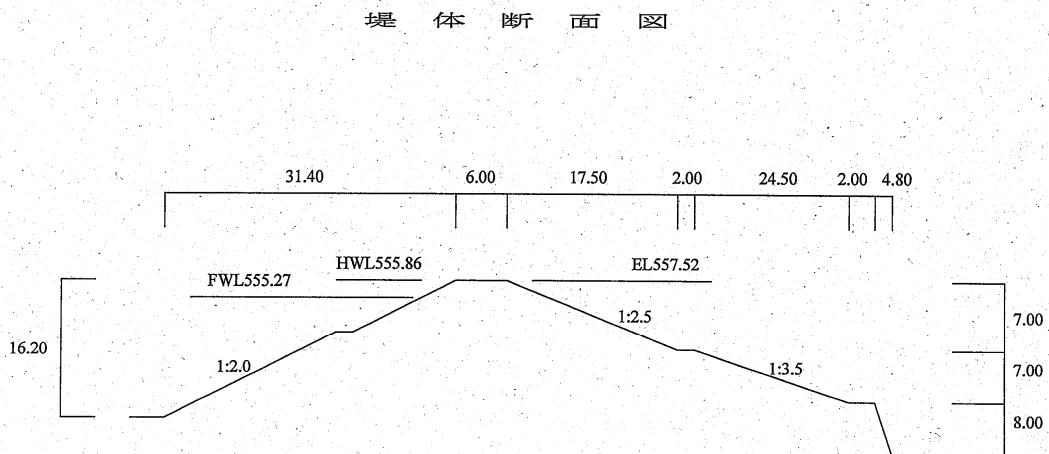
丸山ため池（千代田湖）堤体断面図
